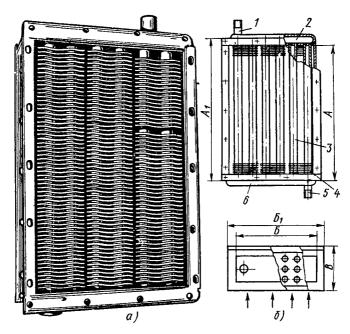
Общий вид (a) и схема устройства (b) пластинчатого калорифера:
